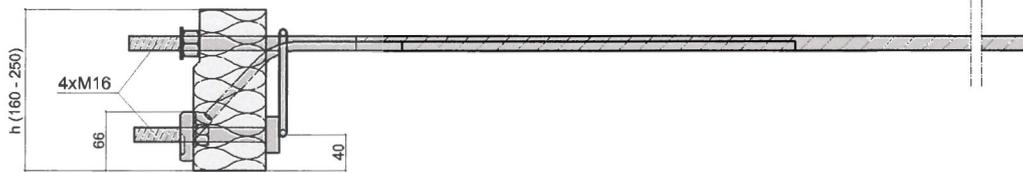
Bauseitige Stirnplatte zu Schöck Isokorb Typ RKS10
